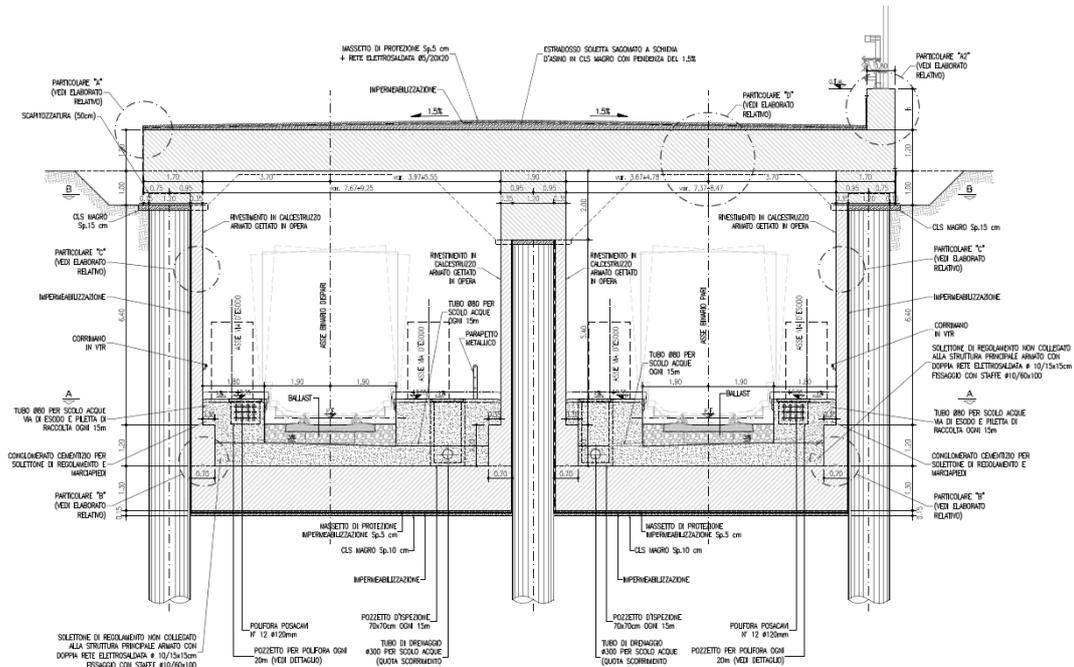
Sezione tipica M2 bis (doppia canna con setto finestrato)
